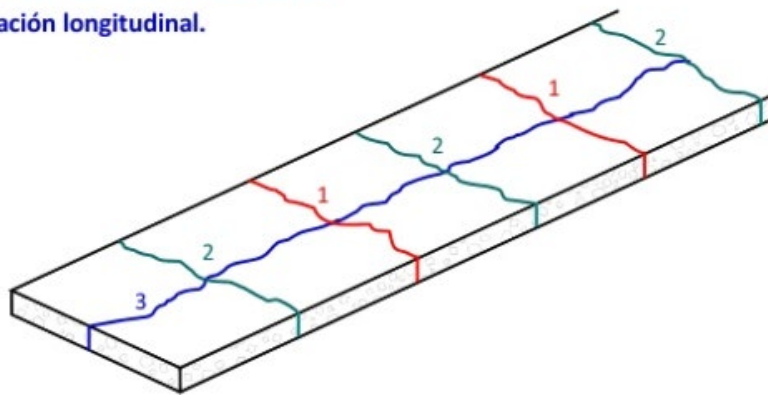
Diagrama de Fisuración. – Fuente: Instituto del Cemento Portland Argentino.
